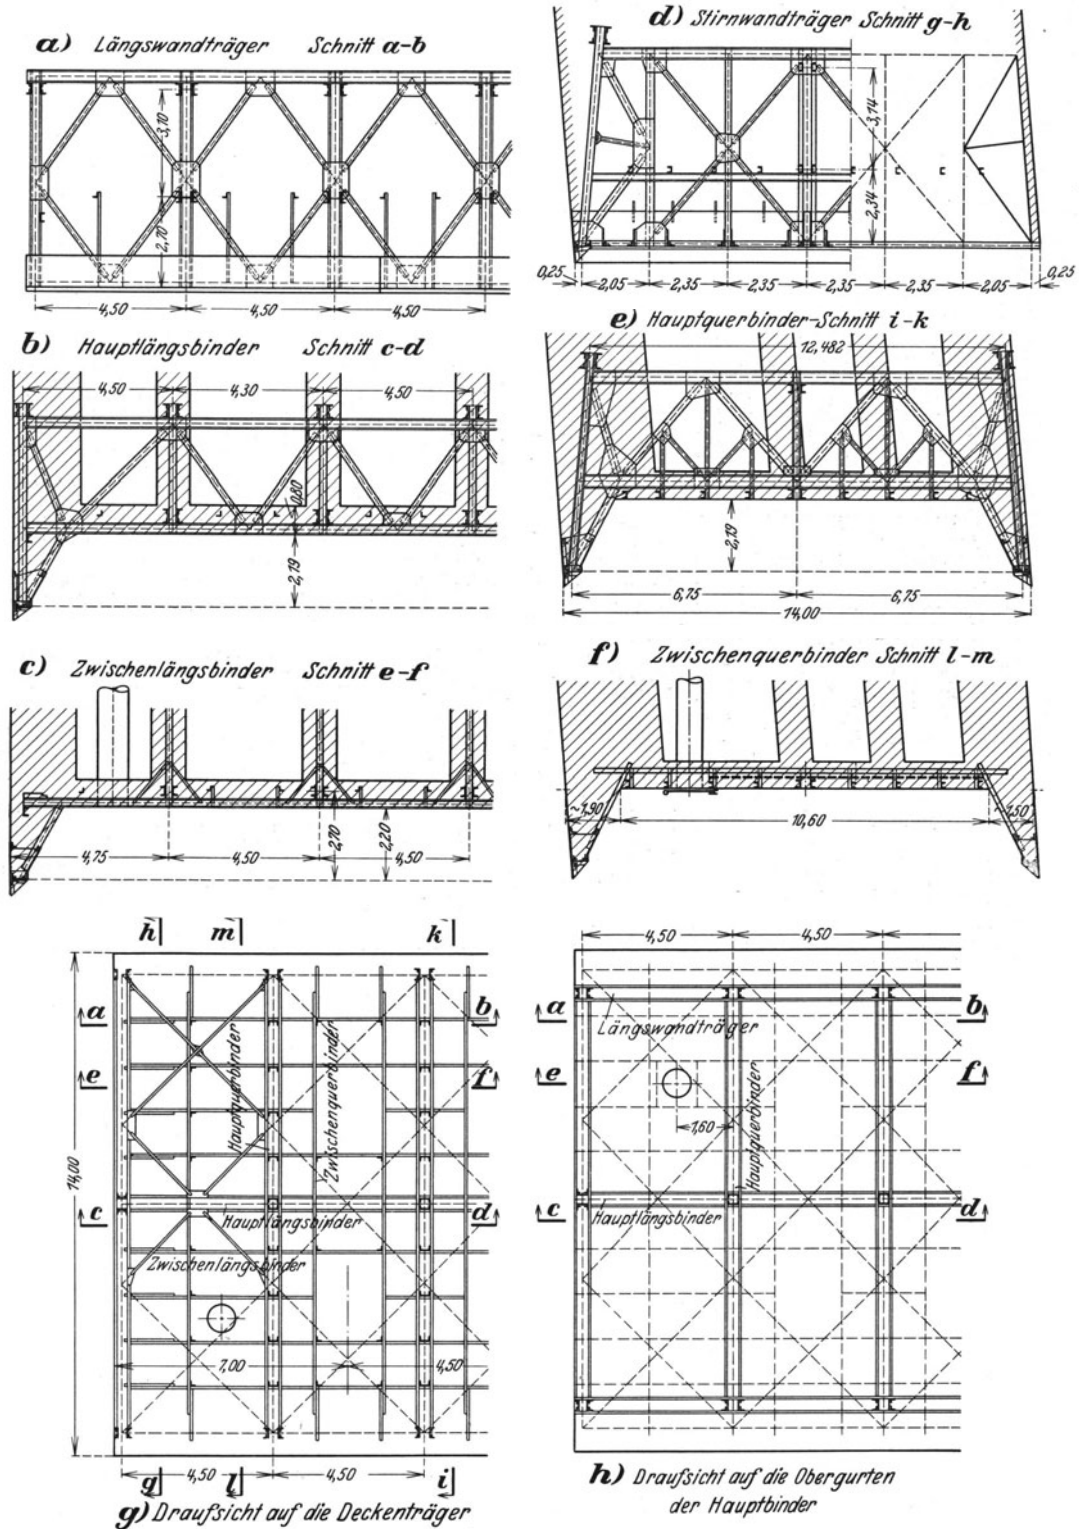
Schräg abgesenkter Druckkasten für die Kanalbrücke in Niederfinow. (Beuchelt & Co.)
